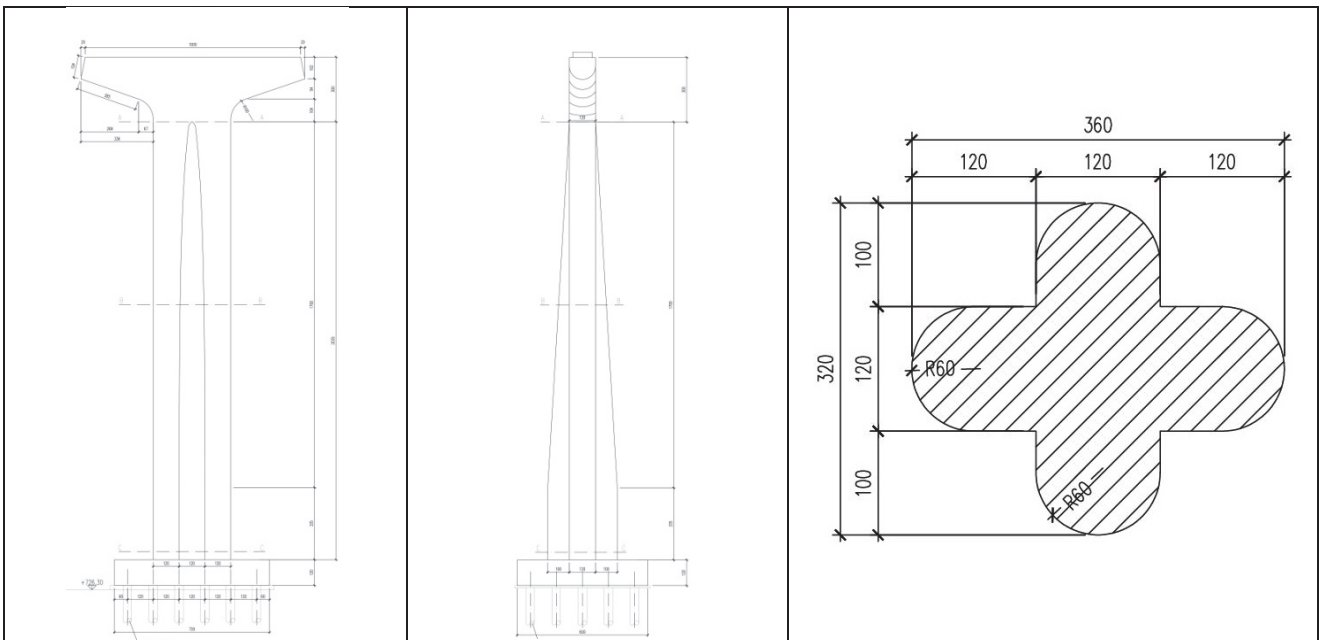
Pila 2: vista trasversale e longitudinale, sezione trasversale di base
